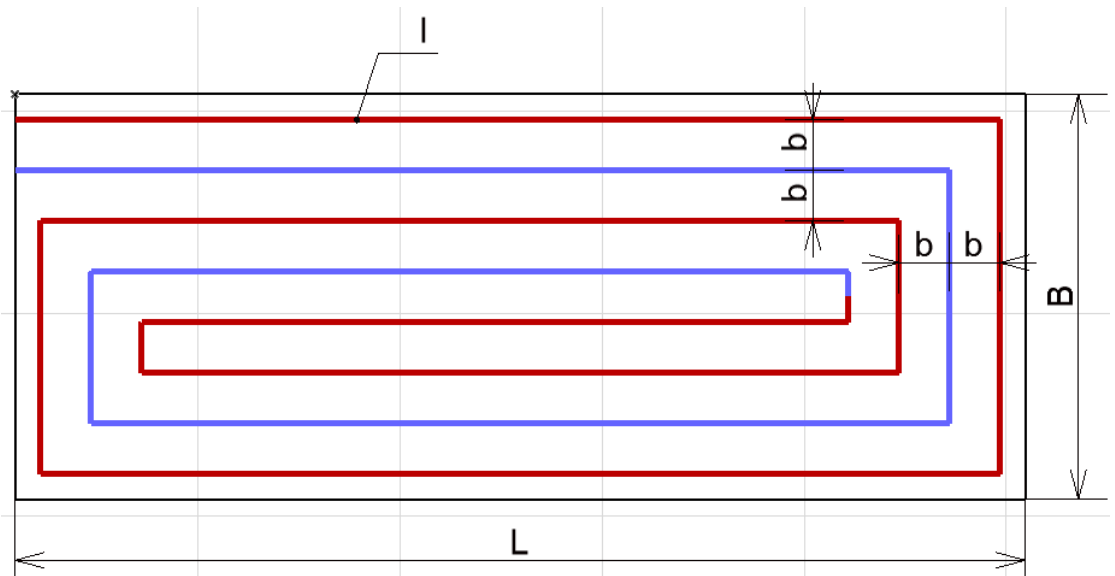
Схема для розрахунку розташування трубопроводів ґрунтового опалення: В - ширина грядки, L – довжина грядки, l – загальна довжина опалювального трубопроводу, b – інтервал між ділянками трубопроводів
